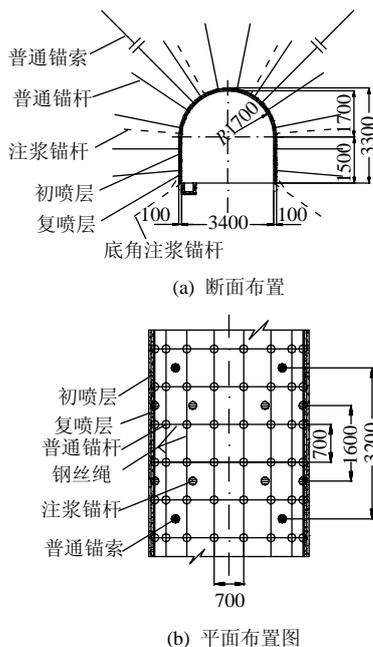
系统绘制的巷道锚注支护施工布置图 (mm)
